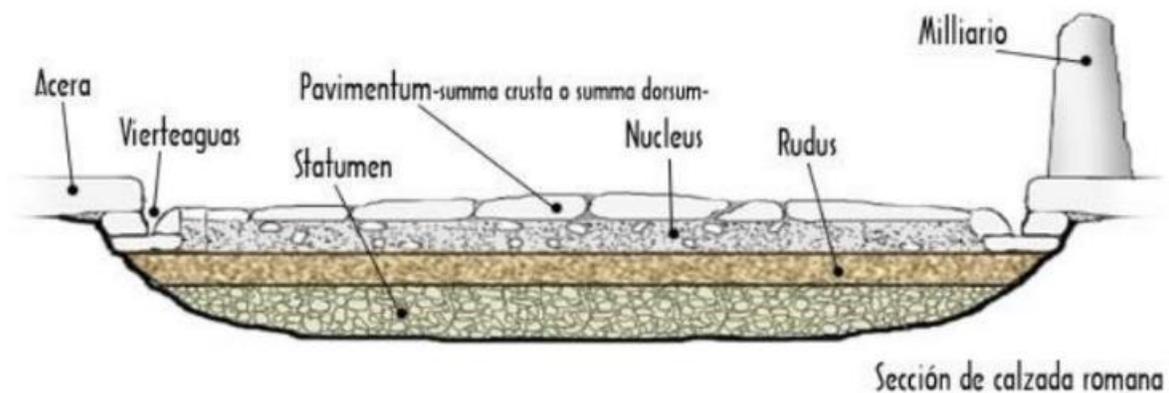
2: Estructura de pavimento construido sobre caminos romanos. Tomado (Arenas Lozano H.L, 2015)
